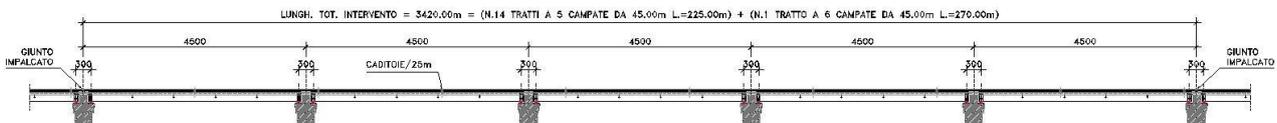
Nuovo impalcato a 3 travi – Schema di distribuzione in direzione longitudinale
